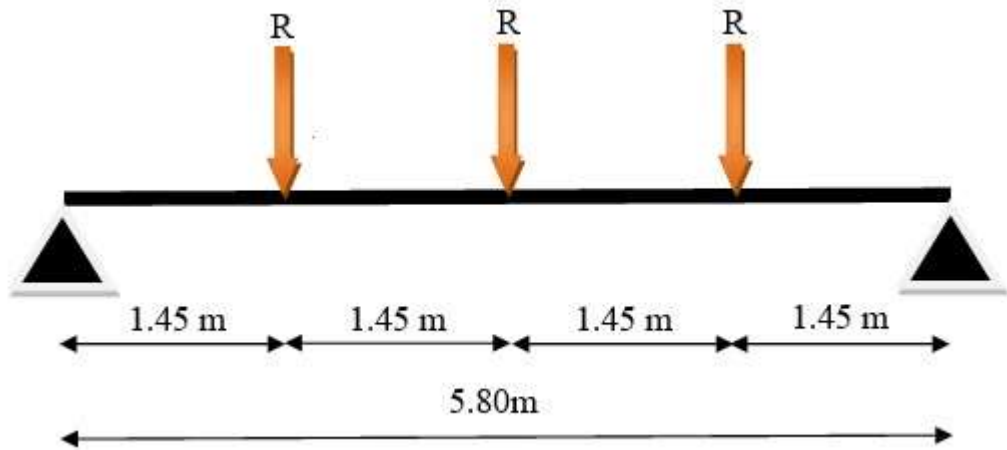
Schéma statique de la poutre principale (terrasse).
